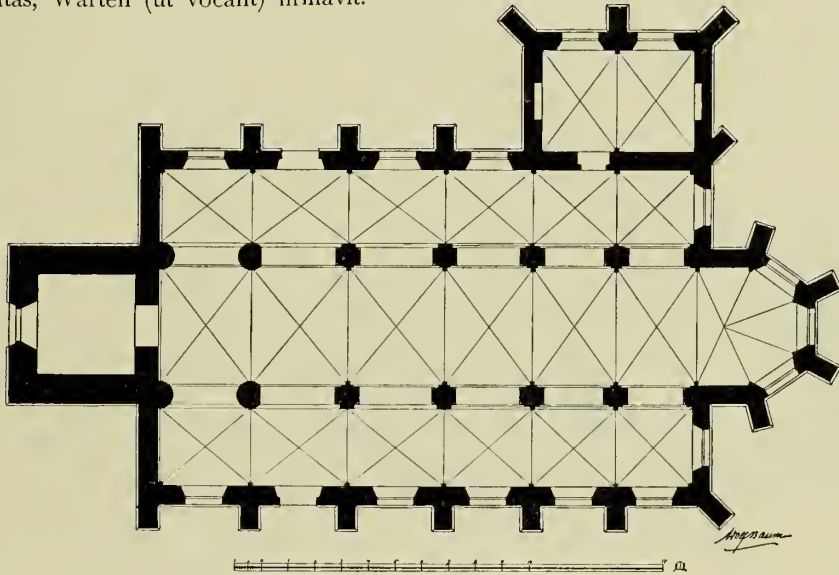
Hünxe. Grundriss der evangelischen Pfarrkirche.
